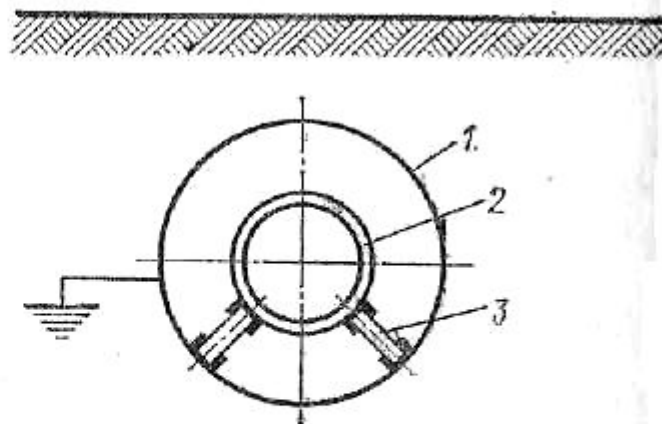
Схема размещения трубопровода в металлическом футляре:
